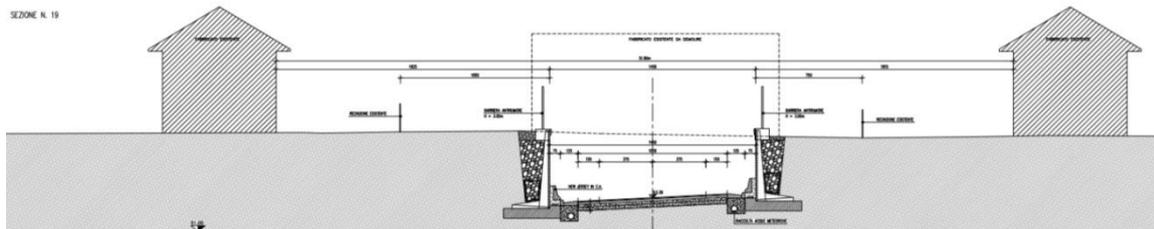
Tratto in scavo - Demolizione di un fabbricato (Sez. n.19)
